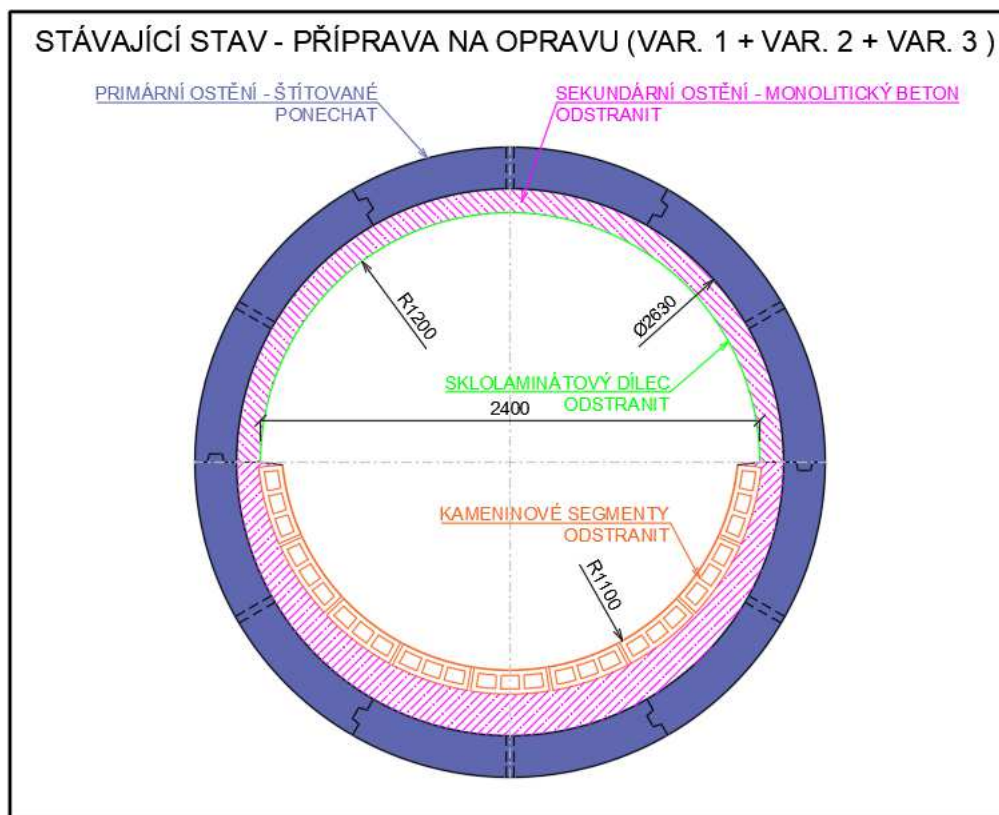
Schéma stávajícího stavu štítované stoky DN 2400/2200
